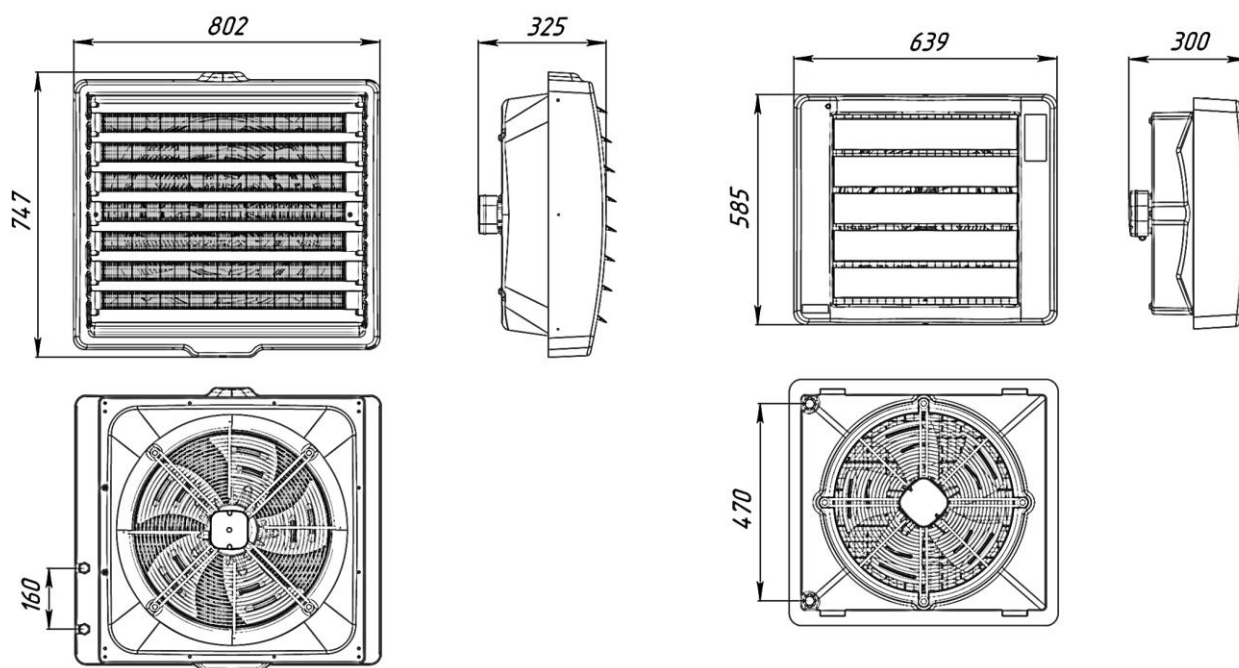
Габаритные размеры тепловентиляторов R11 и R2
